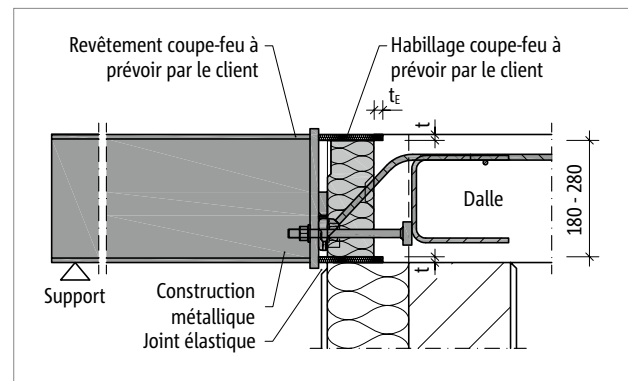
Schöck Isokorb® type SQ : bardage de protection incendie sur site type SQ, structure en acier avec revêtement de protection incendie ; coupe
